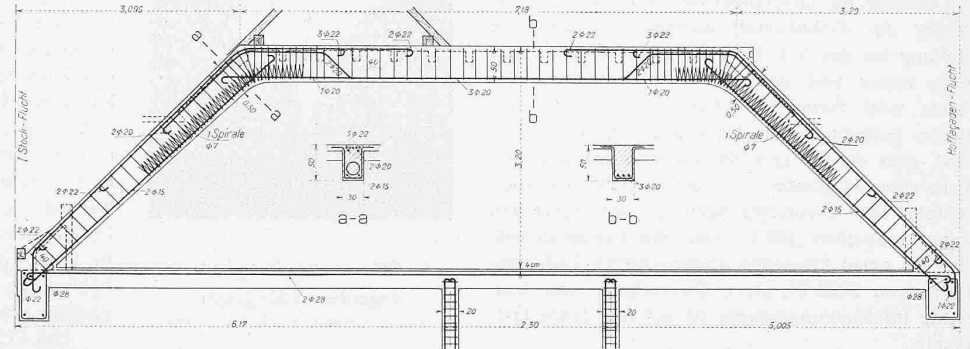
Querkräfte und Momente. — Dachbinder B des Palace-Hotel Bellevue in Bern. — Abb. 16. Armierungsplan 1 : 100.
